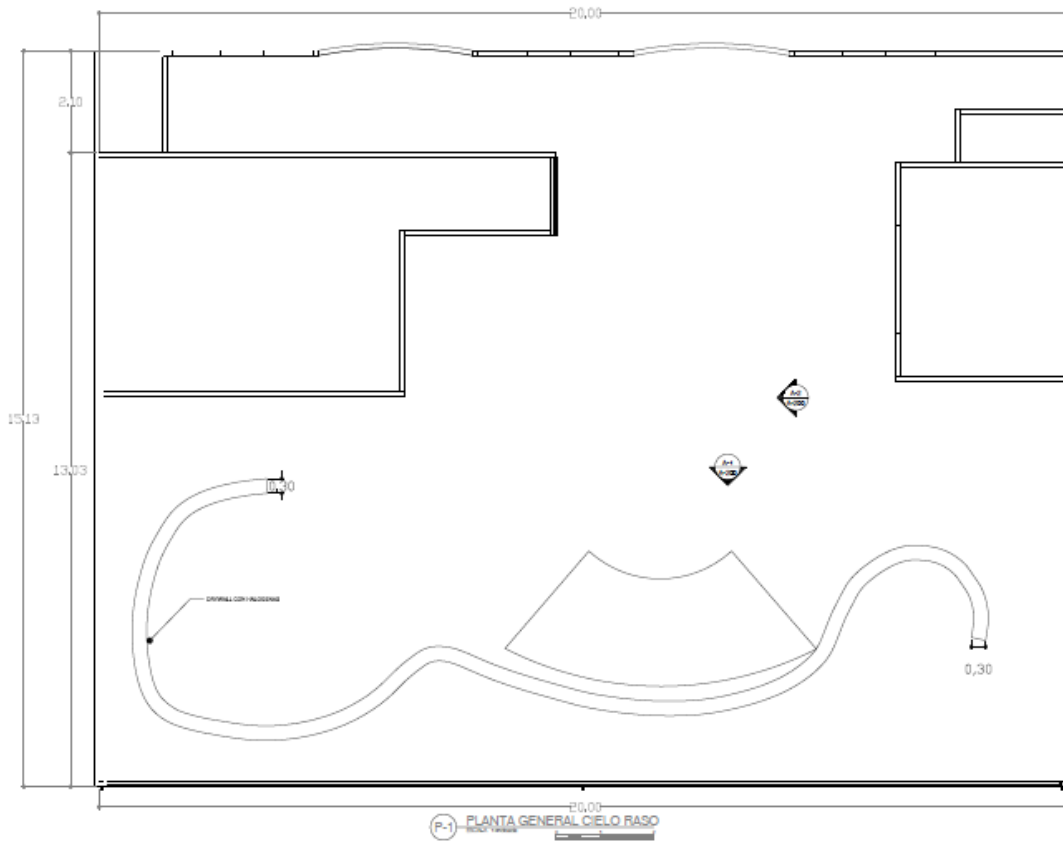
Planta General Cielo Raso. Por Laura Yepes.
